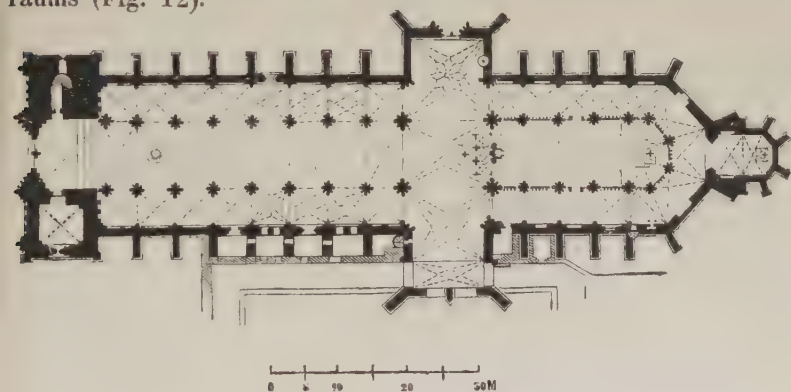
Grundriss des Halberstadter Doms.
